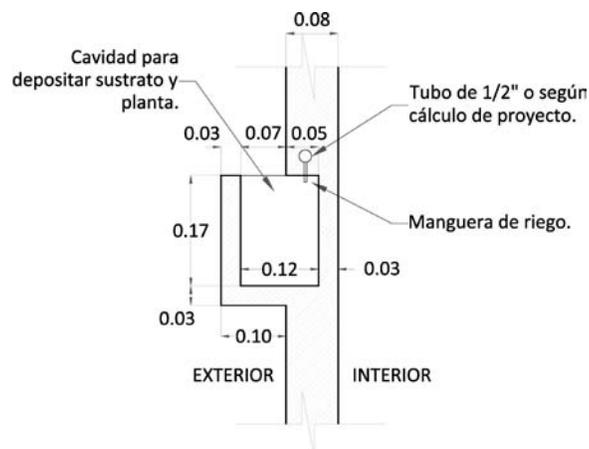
Detalle de panel prefabricado para fachadas vegetales.
